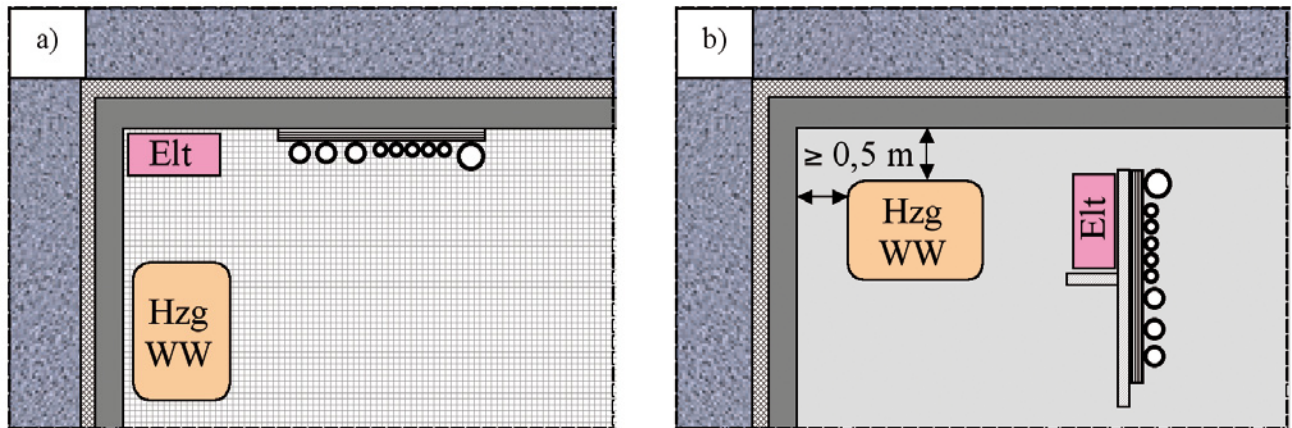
Anordnung von TGA-Komponenten (Grundrissausschnitt)
